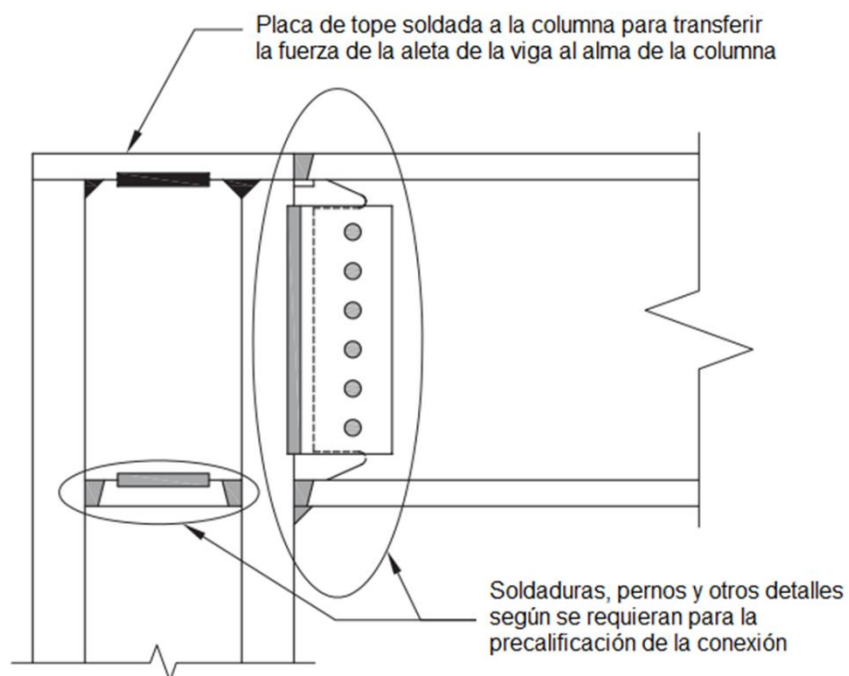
Ejemplo de detalle de placa de tope de la columna para una conexión RBS.
